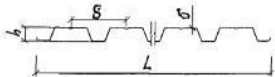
Конструкция монолитного перекрытия с применением стального профилированного настила в качестве несъемной опалубки
